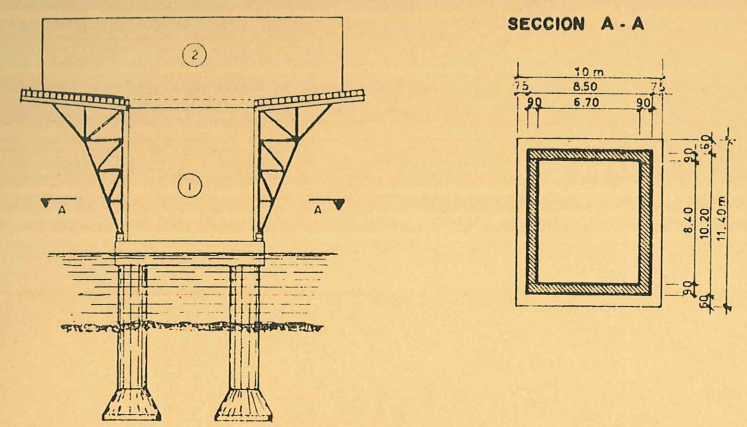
Cimbra adosada a los laterales de la pila mediante vientos para hormigonar las dos primeras dovelas de 6 metros
